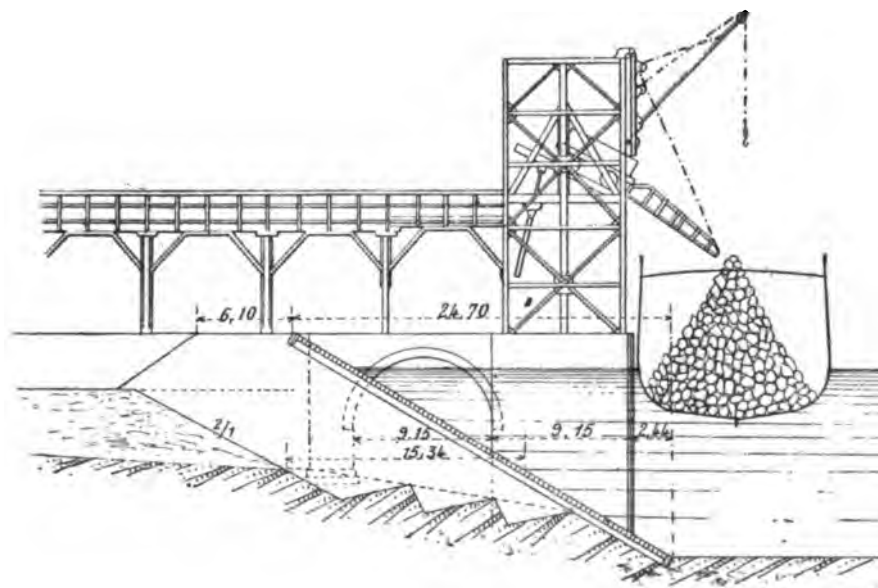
Barry. — Appareil fixe. Coupe verticale.
